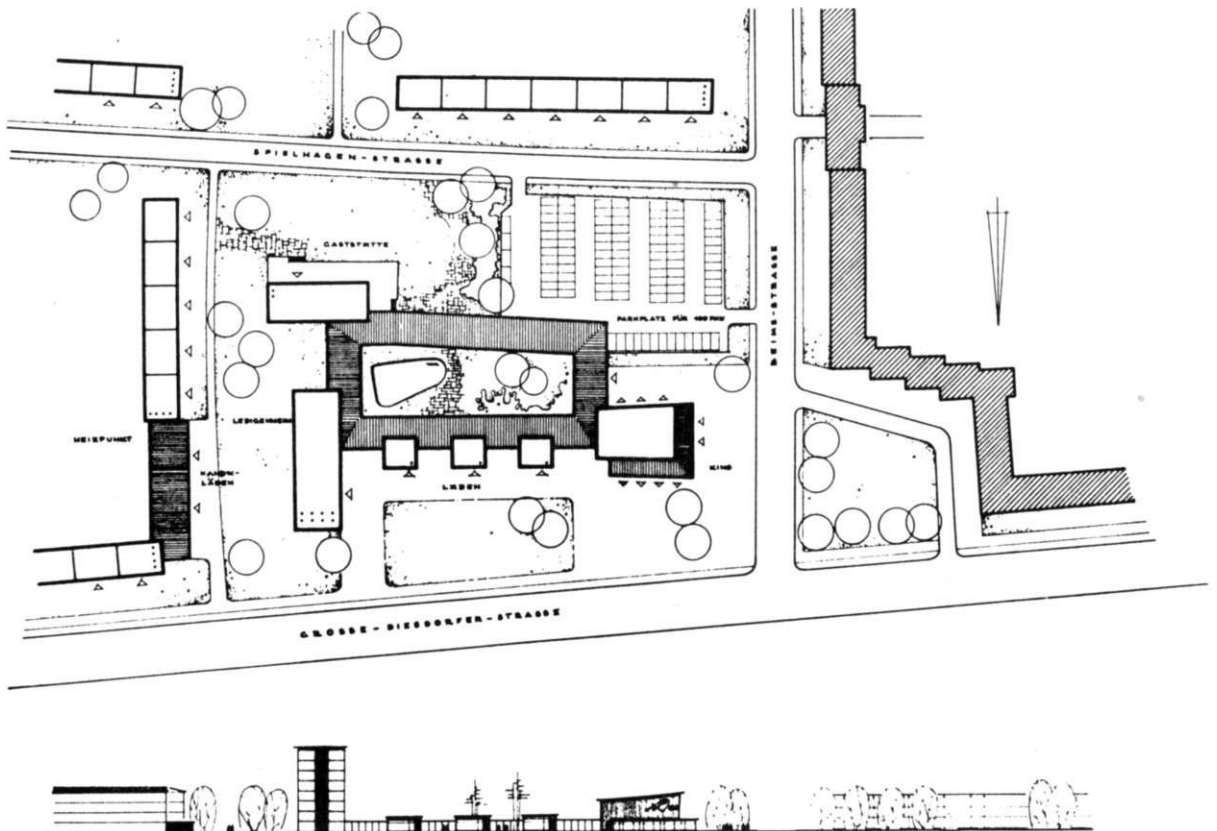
Bebauungskonzeption Spielhagenstraße, um 1965
